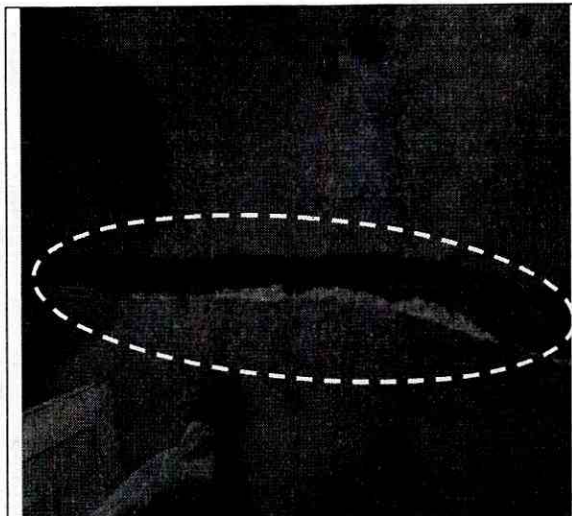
Detalle de la Grieta en placa de contrapiso en la casa No. 1. emplazada en la Carrera 10 Este No. 56-55 Sur.
